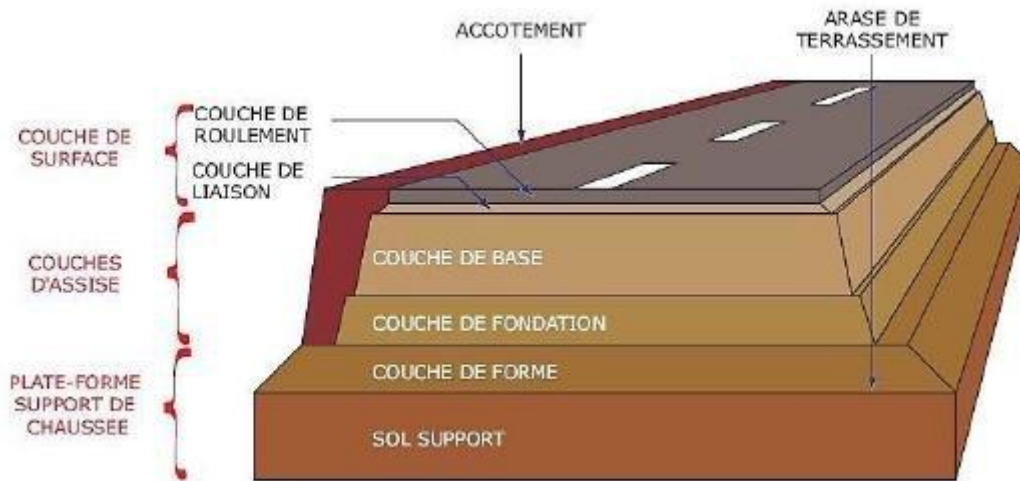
Coupe type d'une structure de chaussée et terminologie des différentes couches
